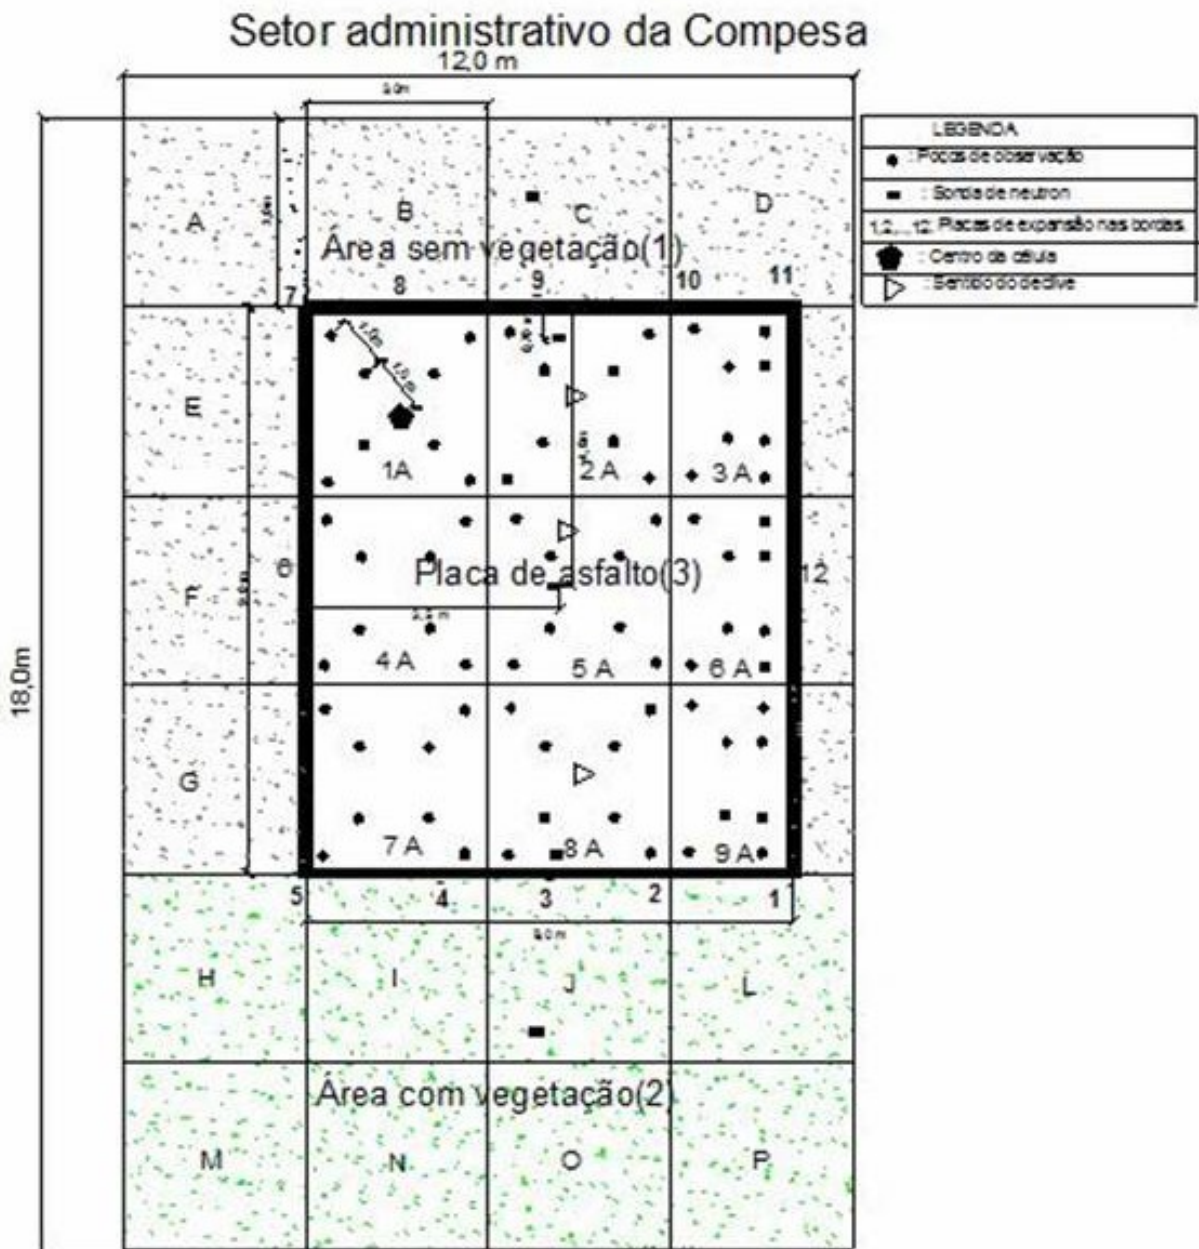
Planta de locação das células geostatística e pontos de observação.
